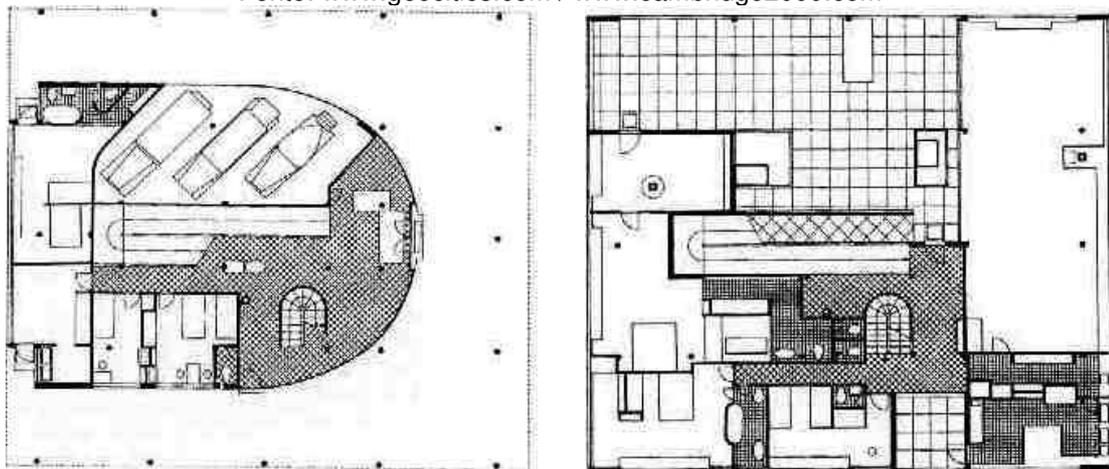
Plantas do pavimento térreo e superior da Ville Savoye
